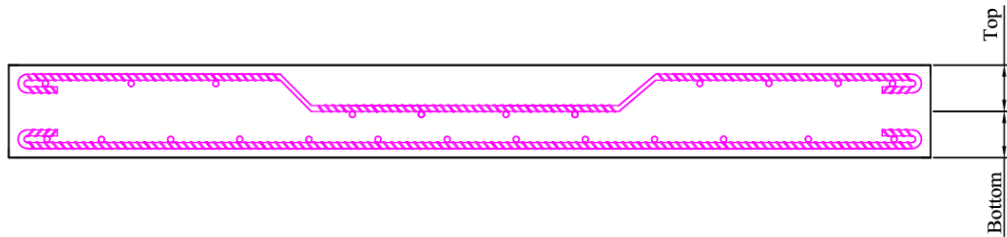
Perfil transversal de la losa maciza (Propia).
